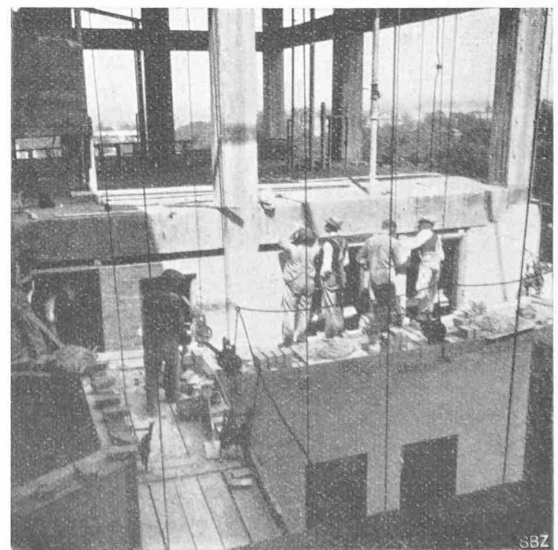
Fassaden-Ausmauerung von Hängergüsten aus.
